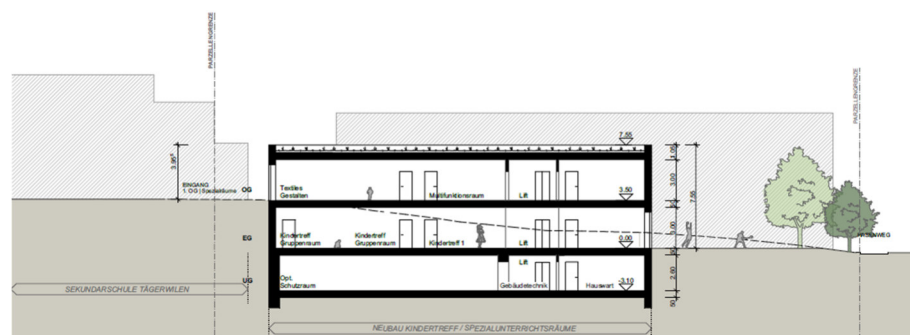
Disposition 01 | Gebäudeschnitt A-A
